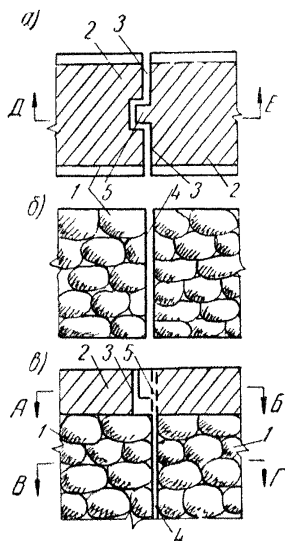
Переход от осадочного шва фундамента к осадочному шву стены
